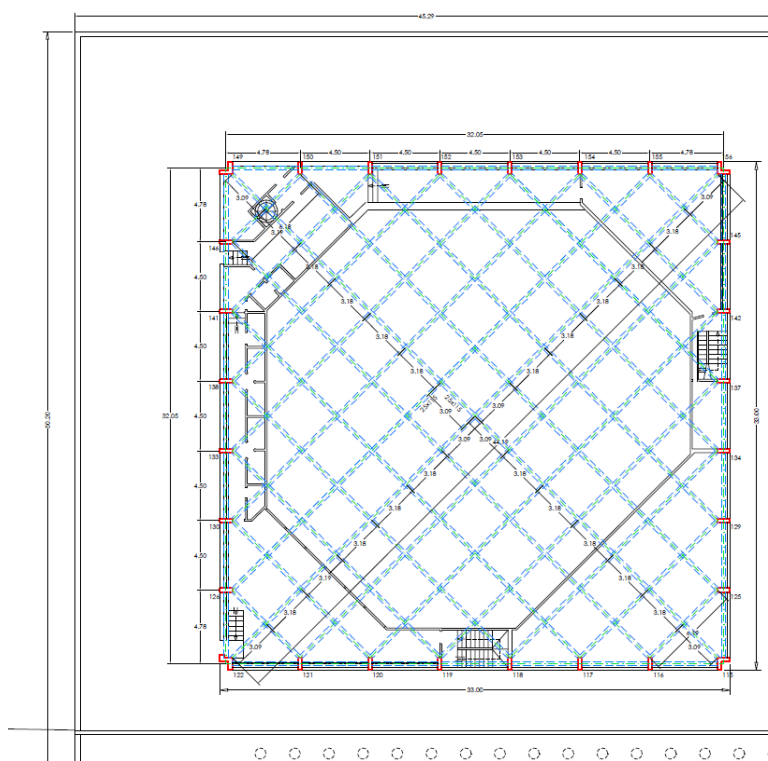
Schema copertura zona centrale del corpo A (Auditorium)
